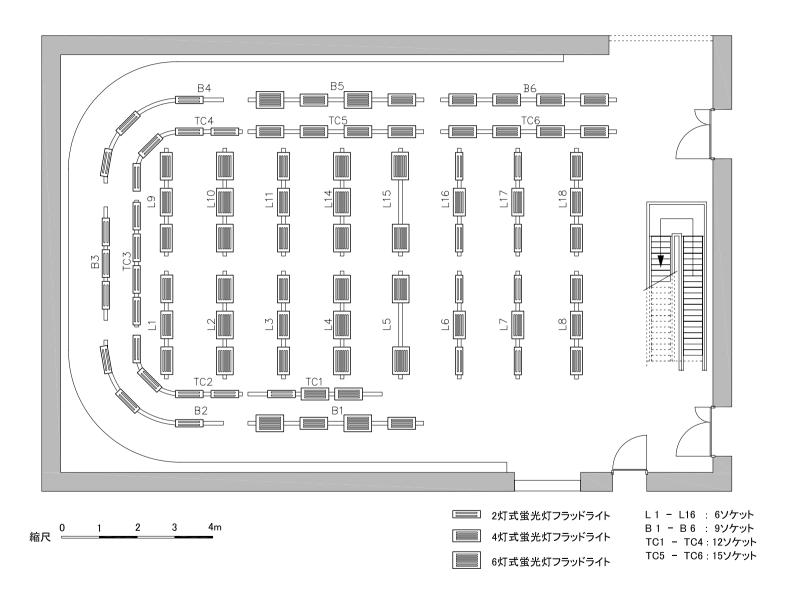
映像教材制作スタジオ-1 スタジオ照明配置図
